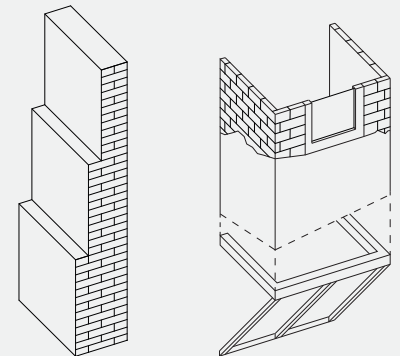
Schema della sezione della muratura e della composizione delle "verandas"
